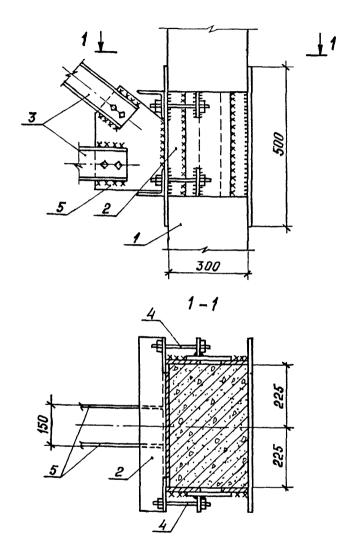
Дополнительное крепление вертикальных стальных связей к железобетонным колоннам
